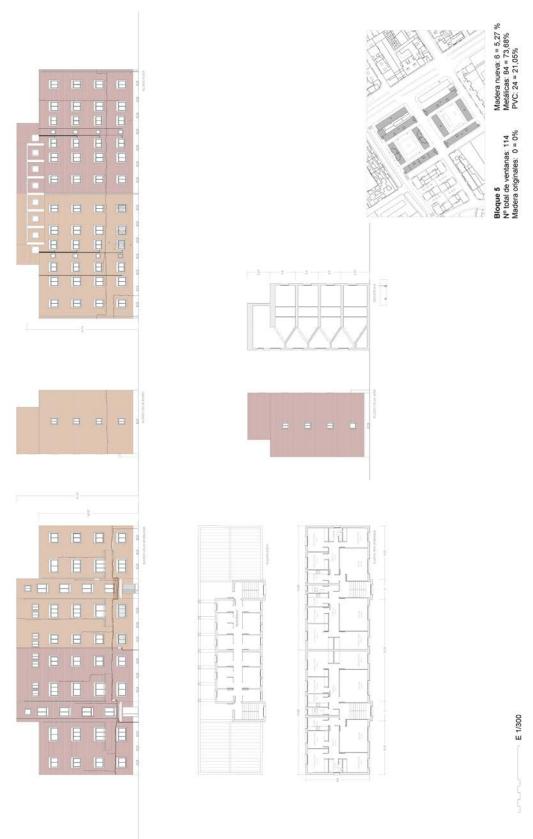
c.22. Planimetría del BLOQUE 5. Obra del Hogar Nacional Sindicalista
